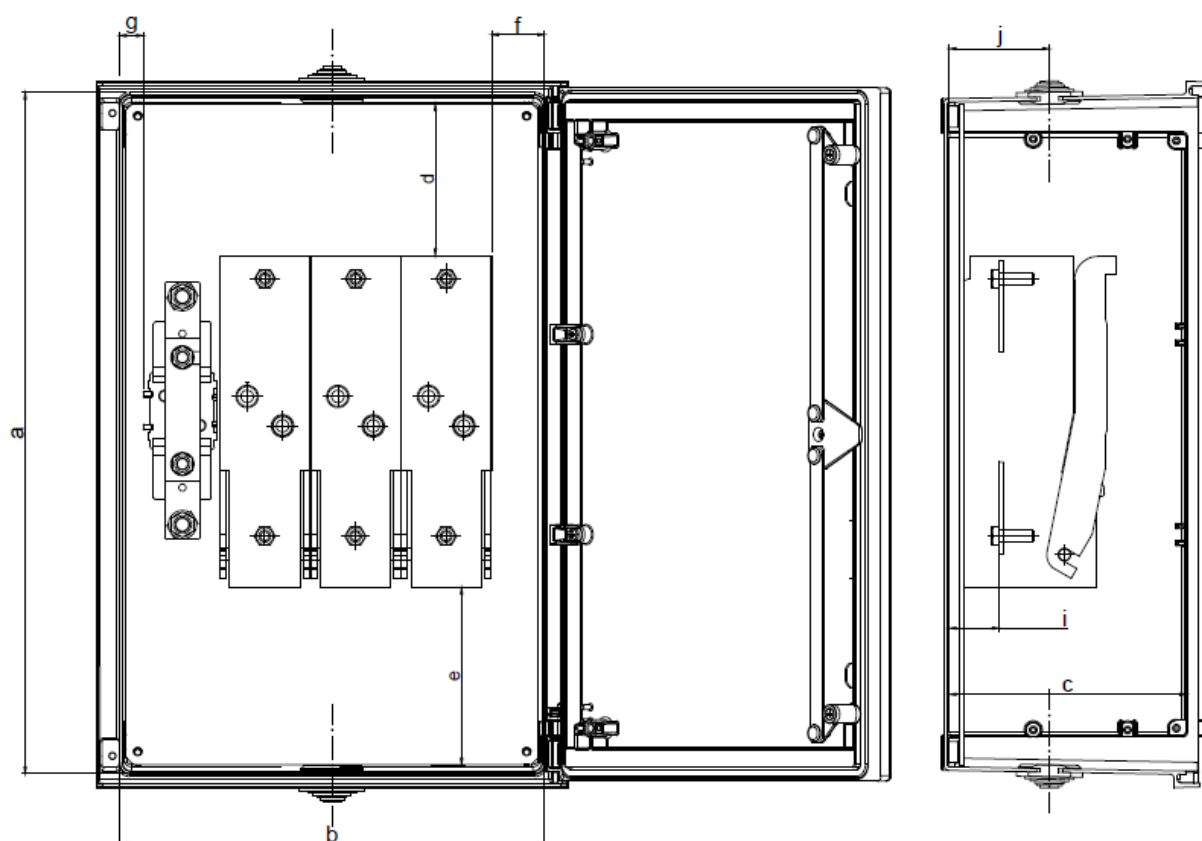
Portinhola PBTE 400 – Disposição e dimensões
